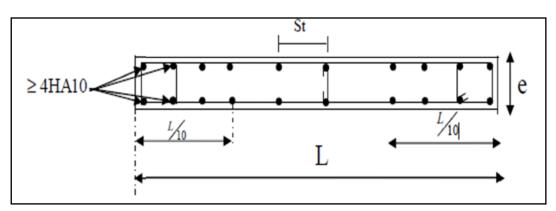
Disposition des armatures verticales dans les voiles
